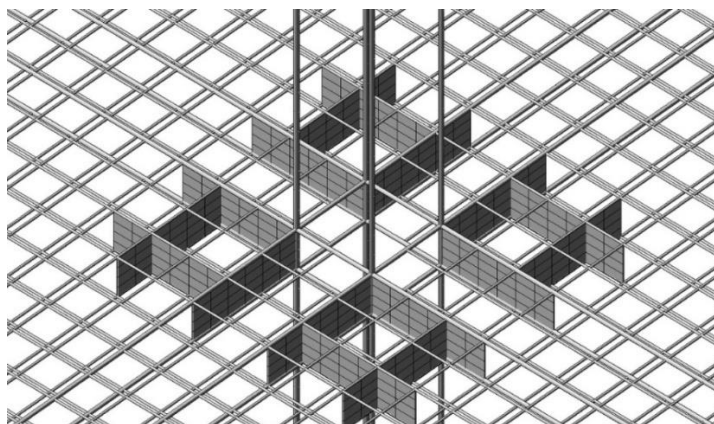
Конструктивное решение безбалочного перекрытия с применением наклонных стержней: 1 – перекрестные наклонные стержни, 2 – бетон, 3 – стержневой арматурный каркас из напрягаемых и/или ненапрягаемых армирующих стержней, 4 – продольная арматура колонн
